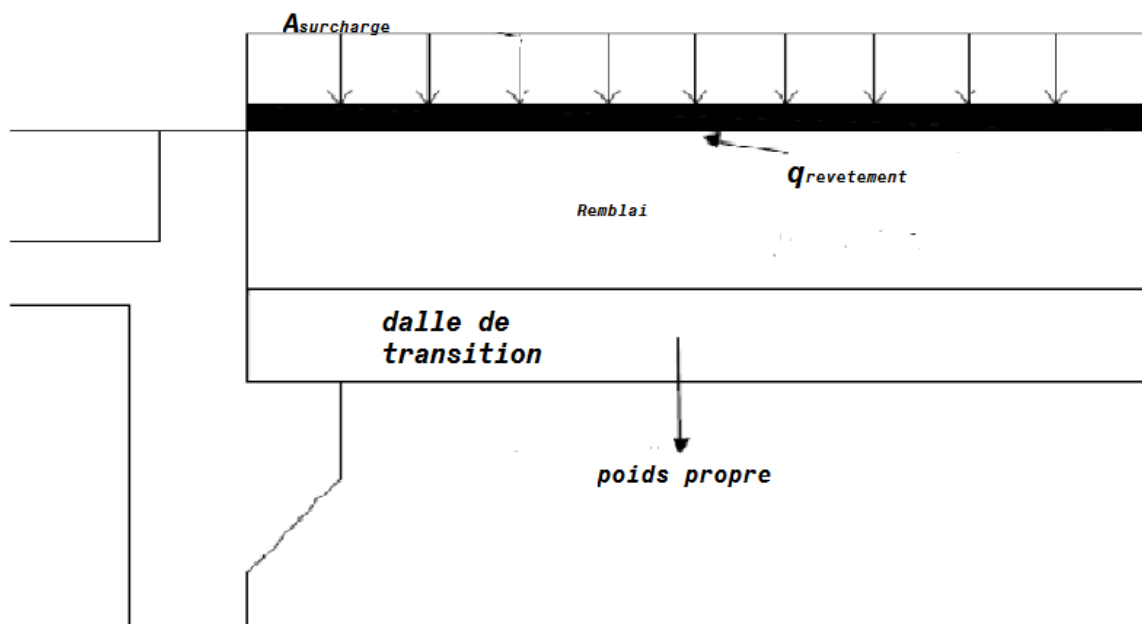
différentes charges et surcharges appliquées sur la dalle de transition
